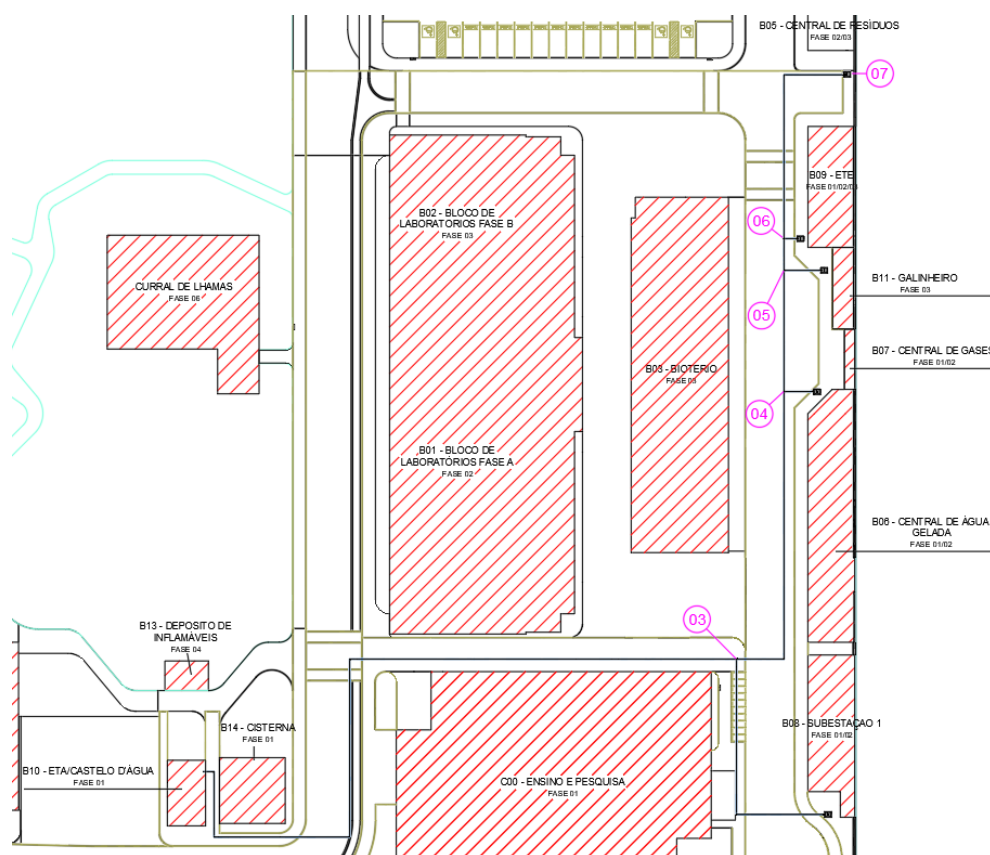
Planta trecho (Castelo d'água / Bloco B05)
